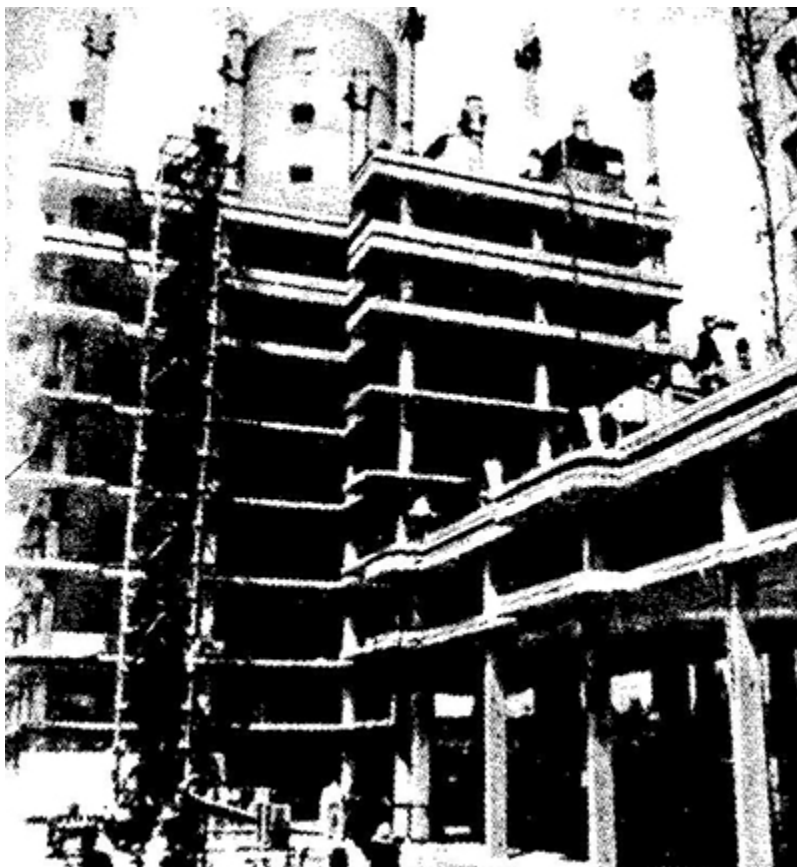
Зведення 16-поверхової будівлі методом підйому перекриттів
